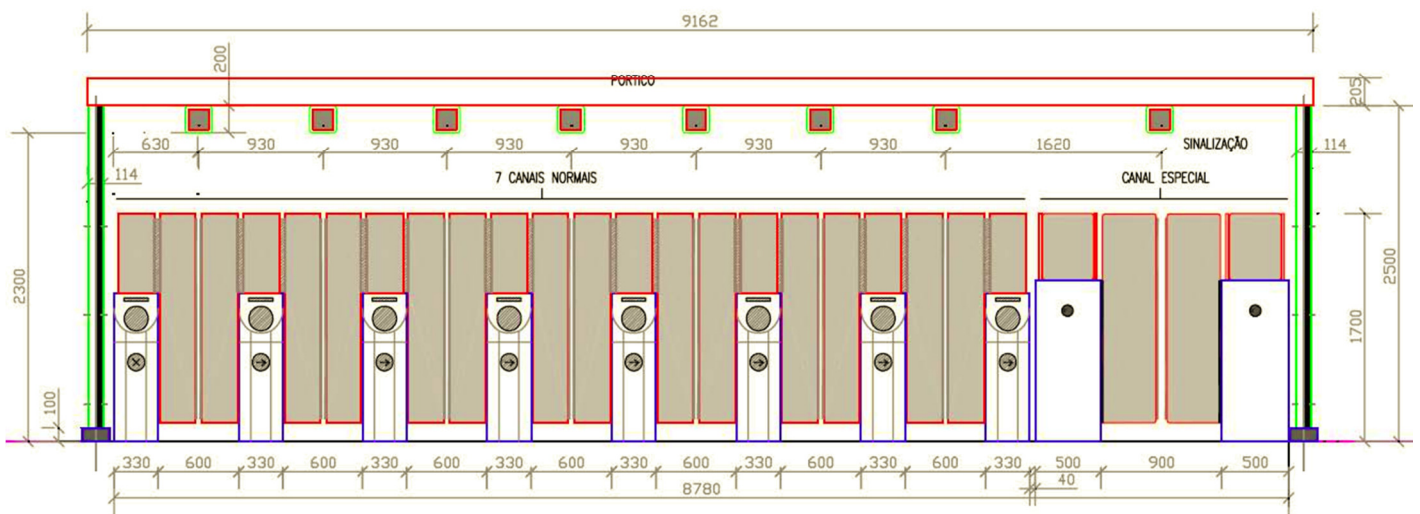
Agrupamento de Canais e Pódico de Suporte da Sinalização Vertical de Apoio
